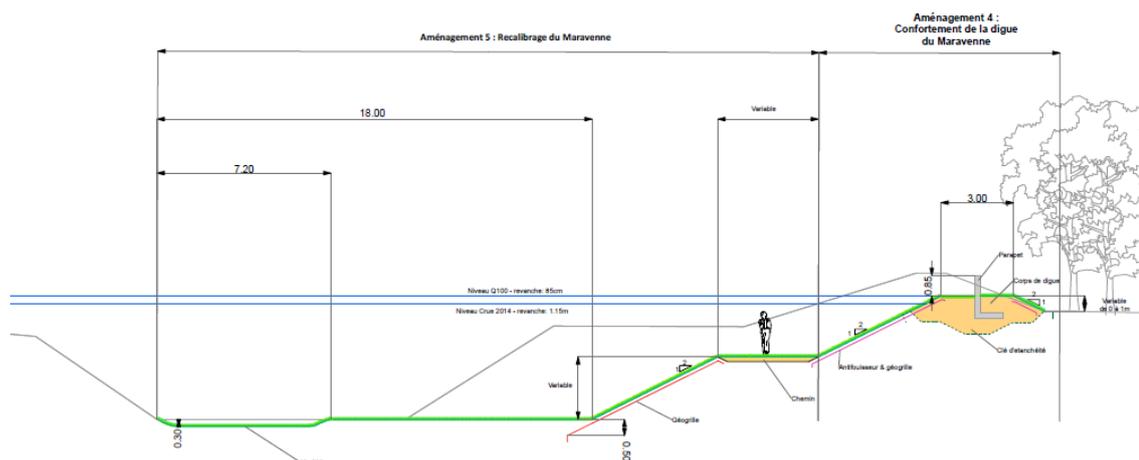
Coupe-type du reprofilage du Maravenne – largeur en fond 18 m
